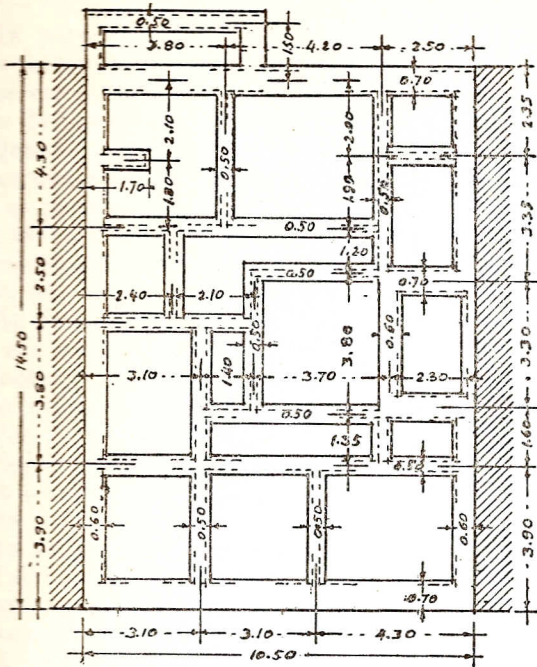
PLANTA DAS FUNDAÇÕES DE UMA CASA ENTRE OUTRAS EDIFICAÇÕES
